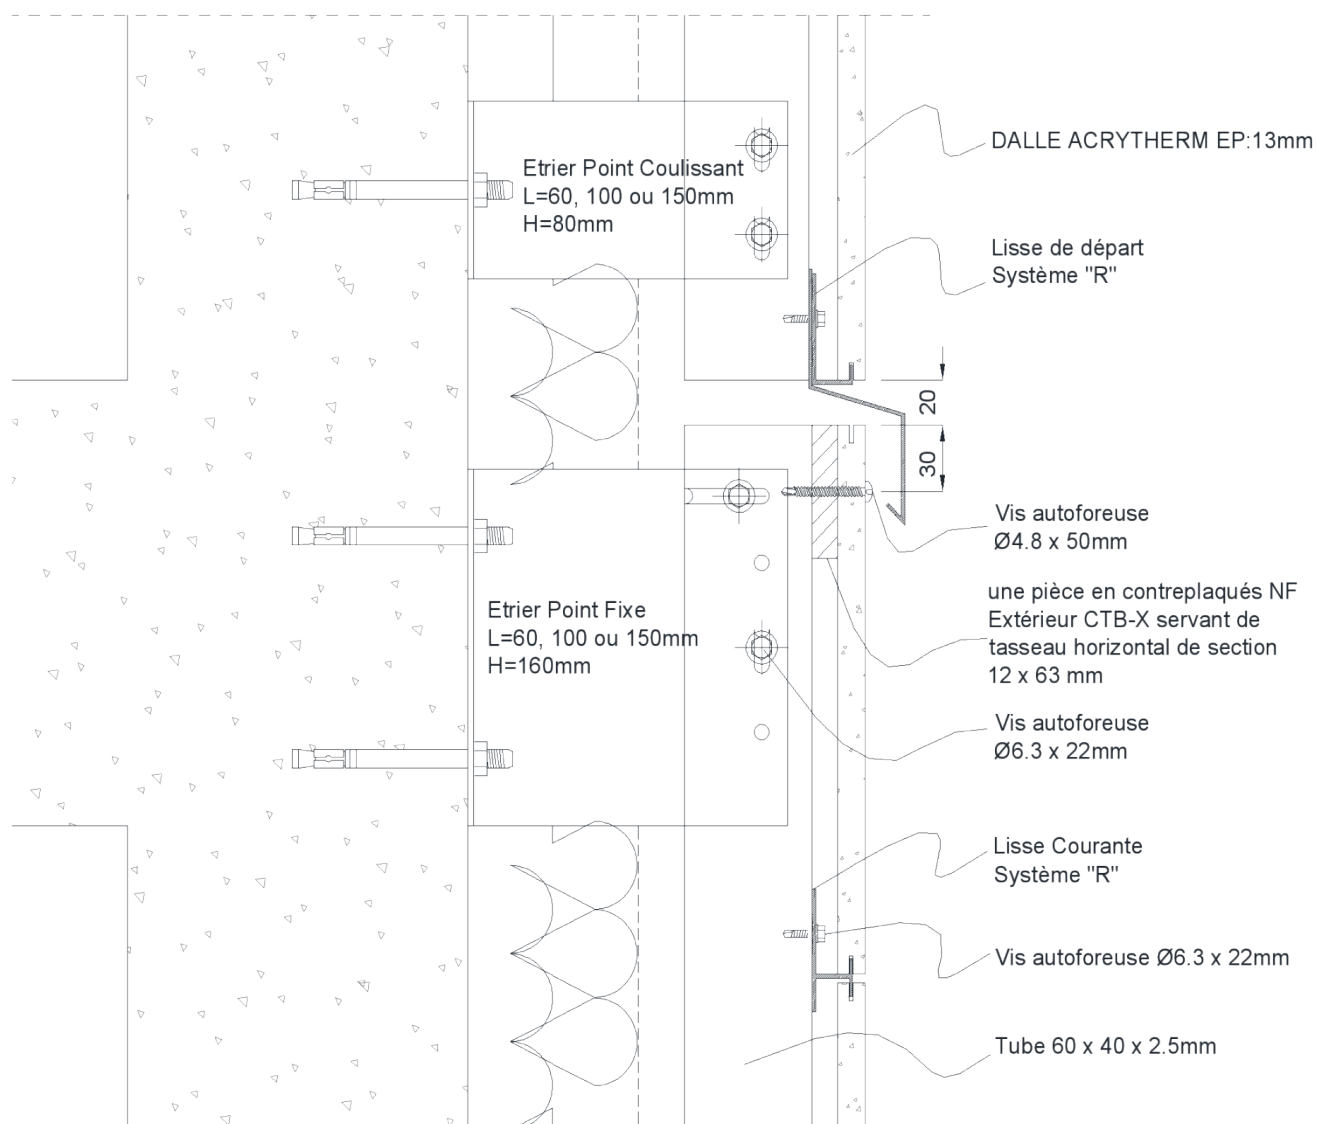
Coupe verticale sur joint de fractionnement au droit de chaque plancher
